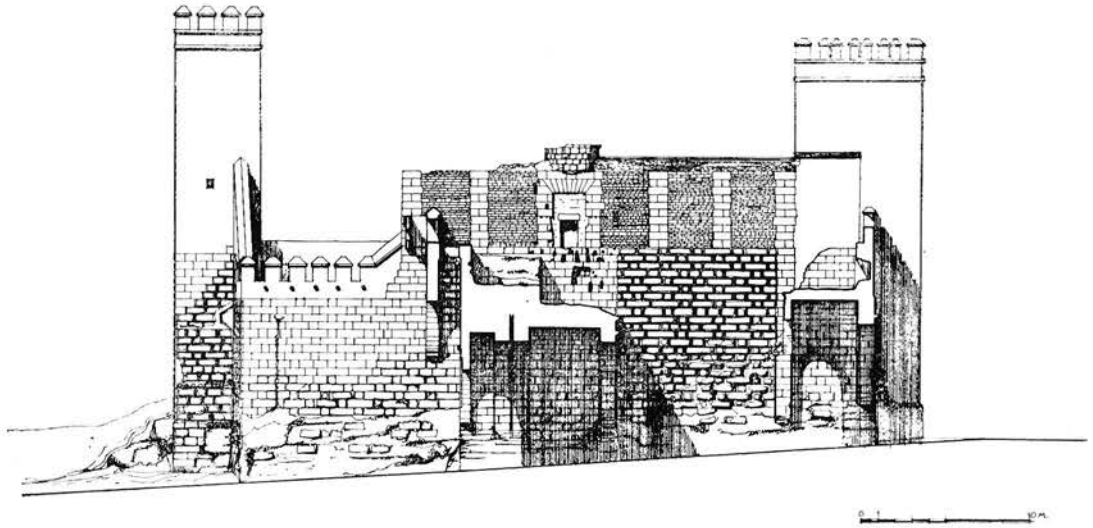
Carmona. Corte de la Puerta Sur de la Puerta de Sevilla
